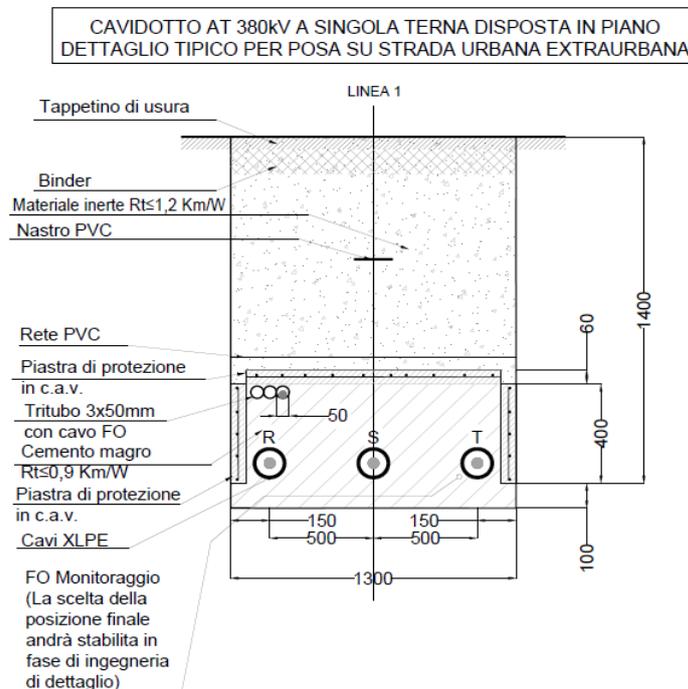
Sezione tipica di scavo e posa elettrodotta 380 kV su strada
